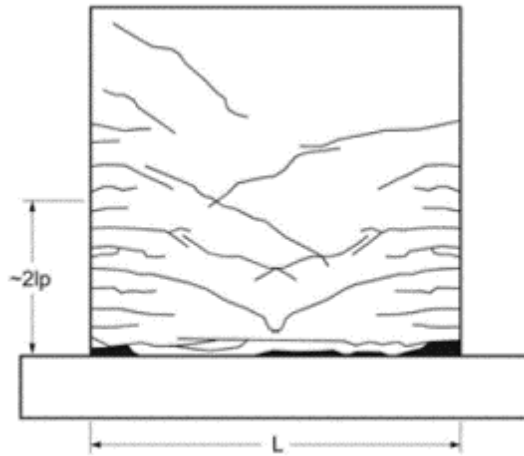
Esquema muro con daño nivel IV con aplastamiento del alma en la base [7]
